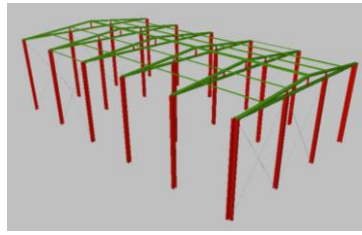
Vivienda 1 planta, análisis estructural CYPE 2017
